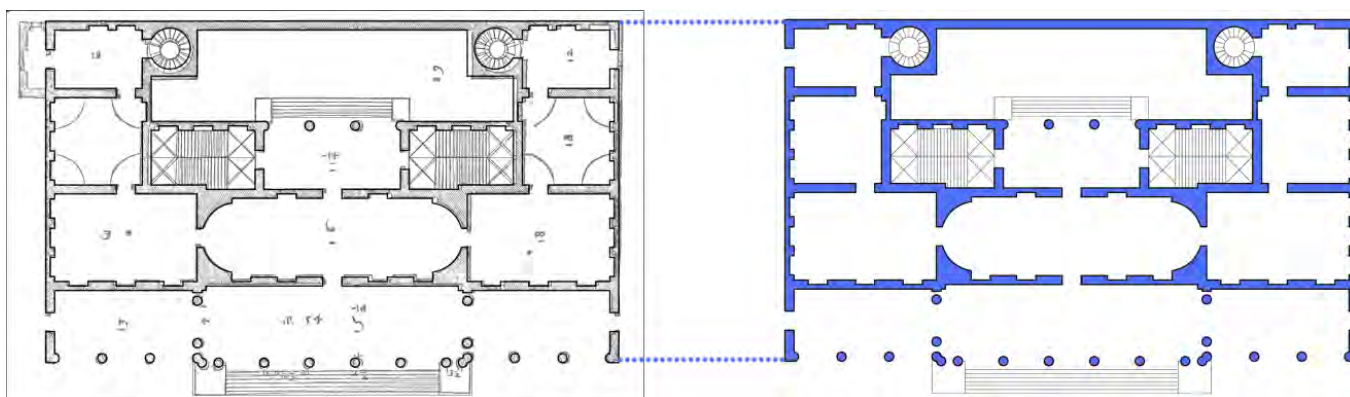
Ridisegno del progetto pubblicato da Palladio e determinazione della pianta del palazzo
